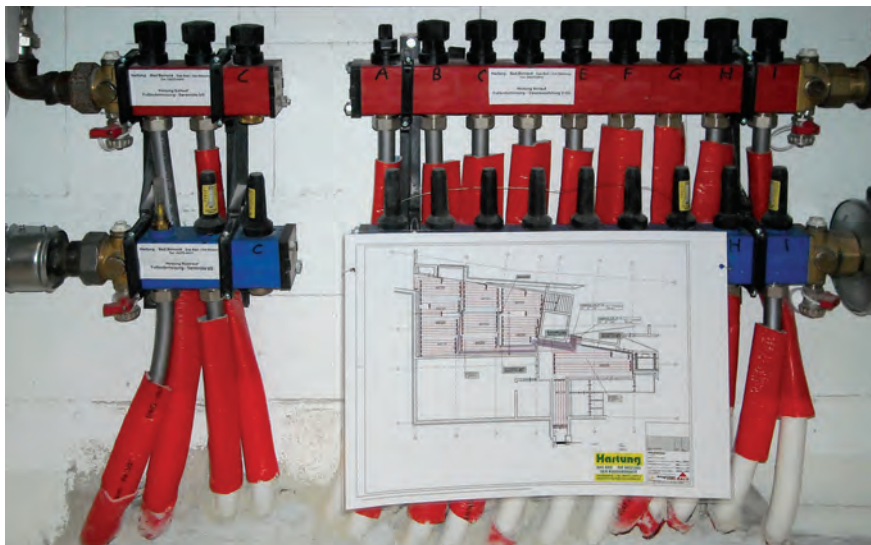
Mehrere Heiz- und Kühlzentralen sind in dem Gebäudekomplex notwendig. Im Bild: PYD-Heizkreisverteiler für Vor- und Rücklauf in Teilbereichen des Untergeschosses des Erweiterungsbaus.
